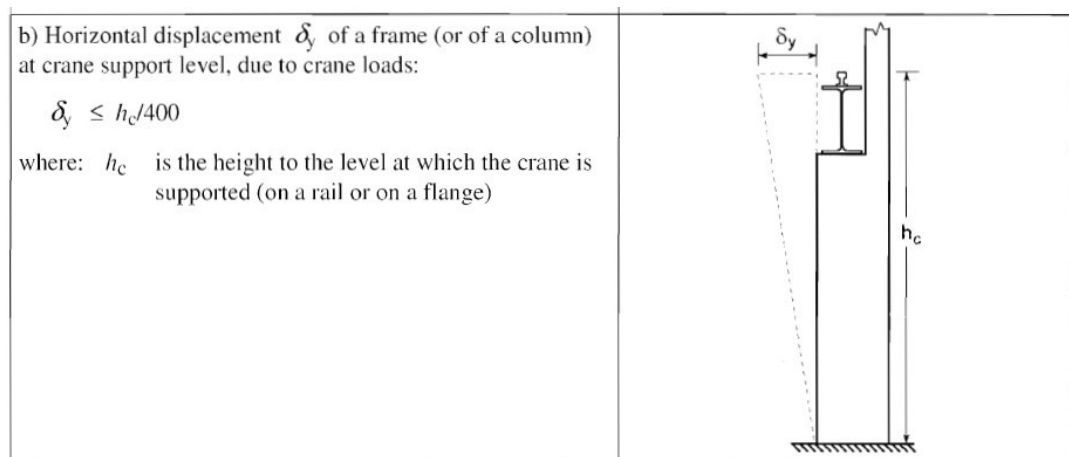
Desplazamiento horizontal máximo de pilar a nivel de viga carril.
